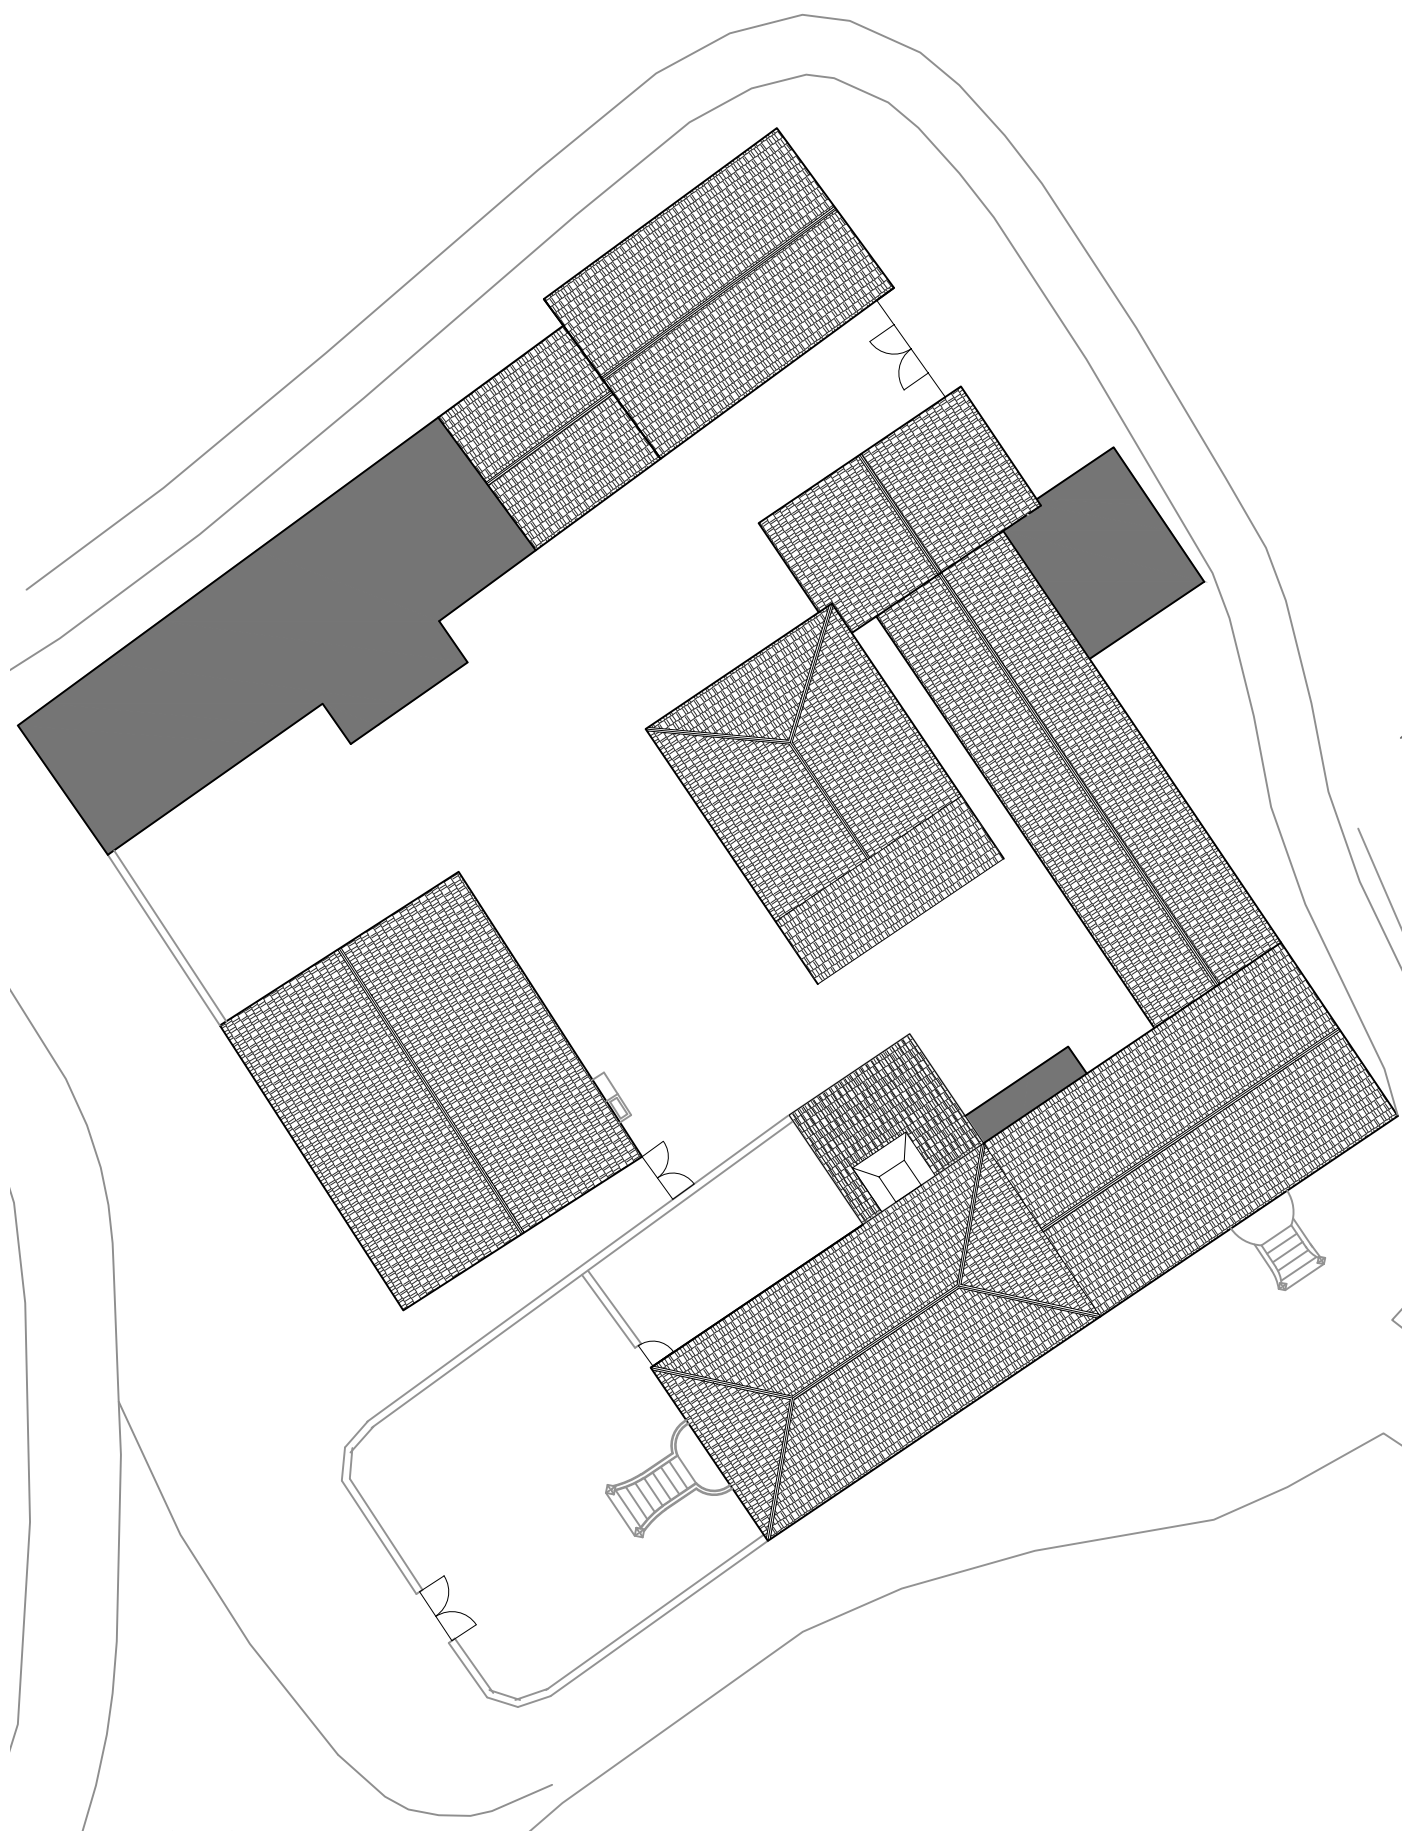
Piso 1 - Planta do Conjunto Arquitetônico
